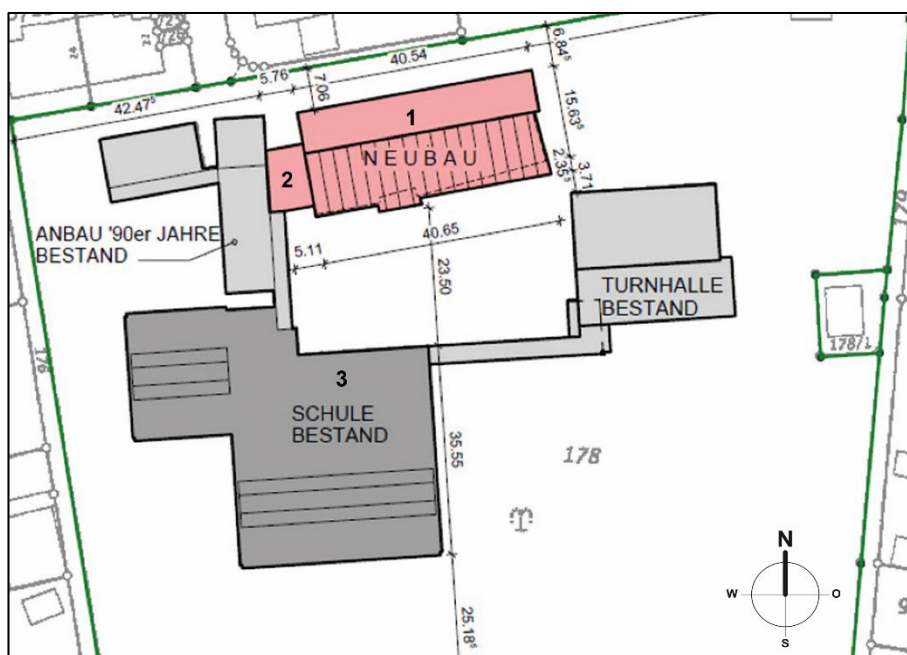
Lageplan der Gesamtanlage der Grundschule Giebelstadt [Quelle: Haase & Bey Architekten].
